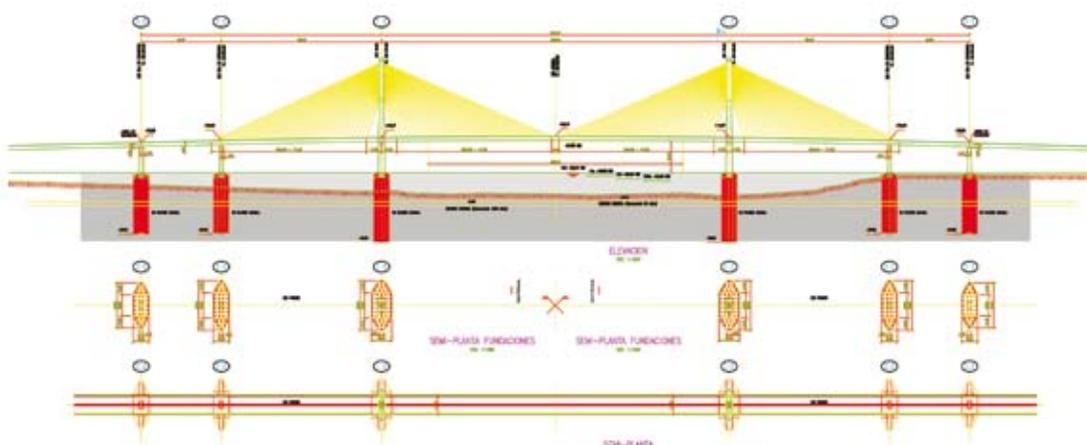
Configuración del Puente Principal, alternativa de hormigón.
